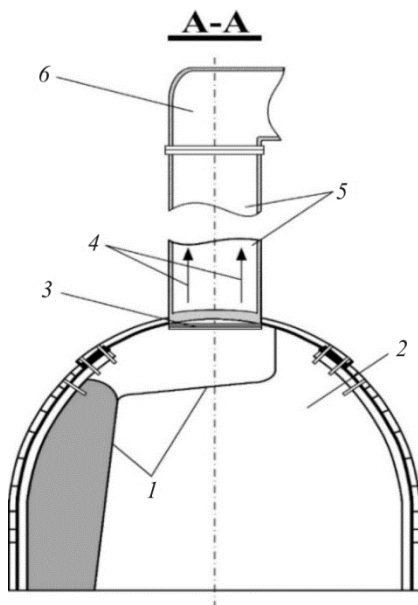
Предлагаемый способ проветривания уклонного блока нефтешахты (разрез по вентиляционной скважине): 1 – теплоизоляционная перегородка; 2 – воздуховыдающая выработка; 3 – конденсатор второй системы кондиционирования воздуха; 4 – нагретый воздух; 5 – вентиляционная скважина; 6 – вентиляционная труба
